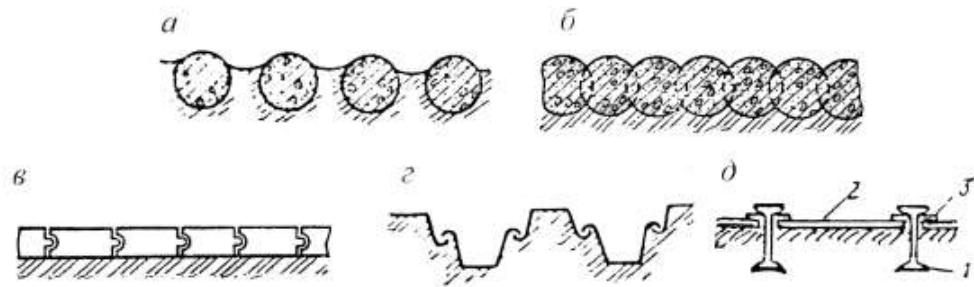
Графічні матеріали з підручника “Механіка ґрунтів, основи та фундаменти”. Огороджувальні конструкції стін (котлованів): а) - буронабивні палі; б) - залізобетонна стінка з палі; в) залізобетонний шпунт; з) - металевий шпунт; д) - прокатний профіль; 1 - двотавр; 2 - огорожа з дощок; 3 - рейка [11].
